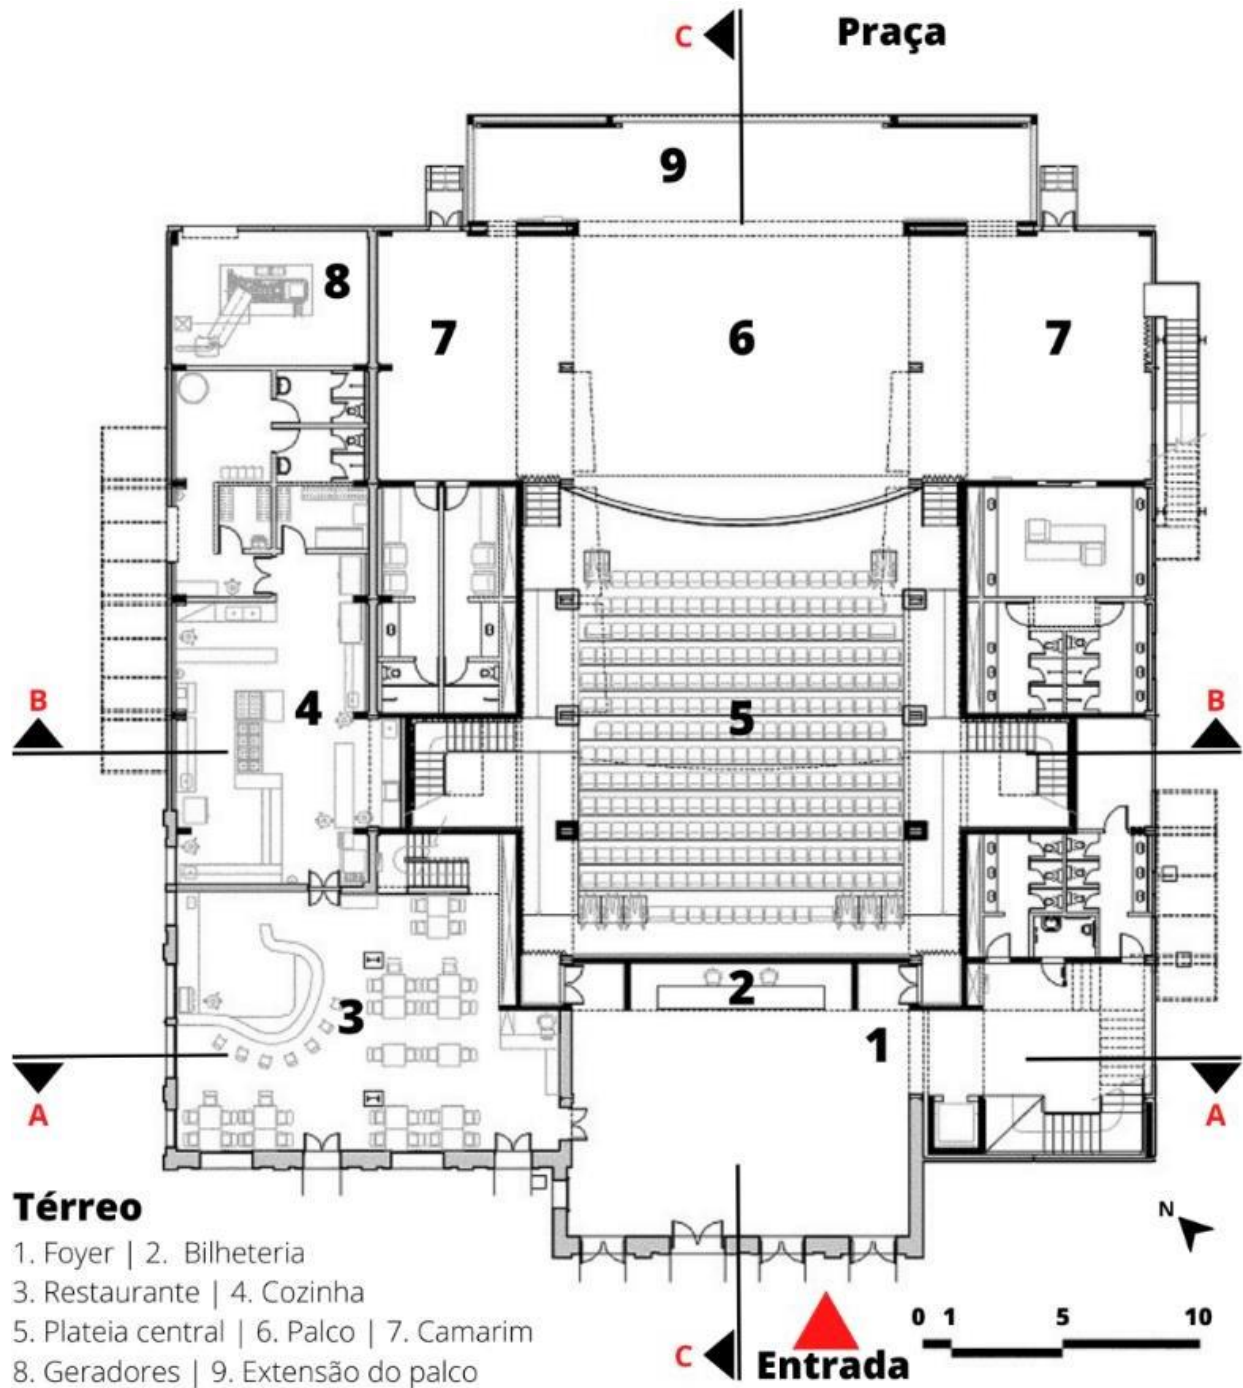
planta baixa térreo do Teatro Erotides de Campos.
